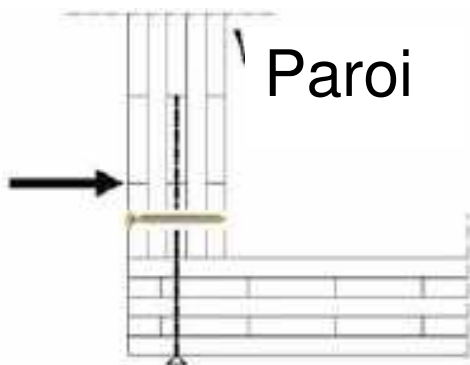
Renforcement par des vis d'éléments de construction faits de planches en bois contreplaqué lors d'une sollicitation en traction perpendiculaire aux rives
